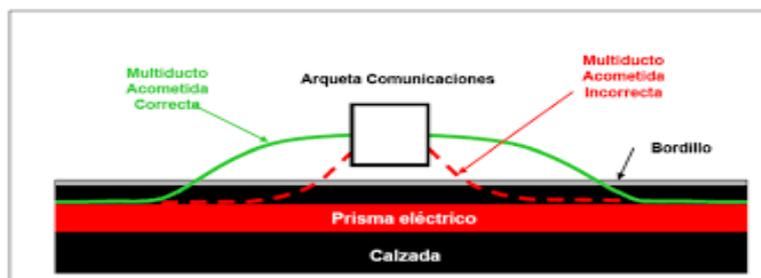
Detalle en planta de la colocación arqueta comunicaciones
